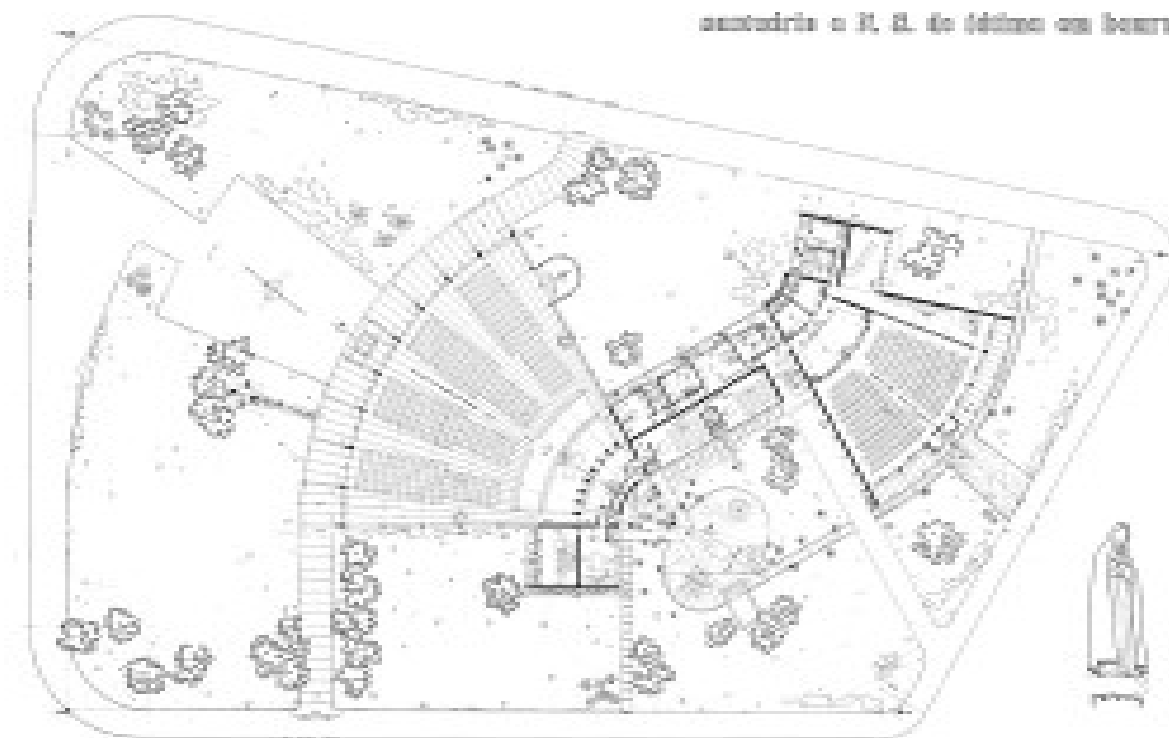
Planta: Santuário Nossa Senhora de Fátima
